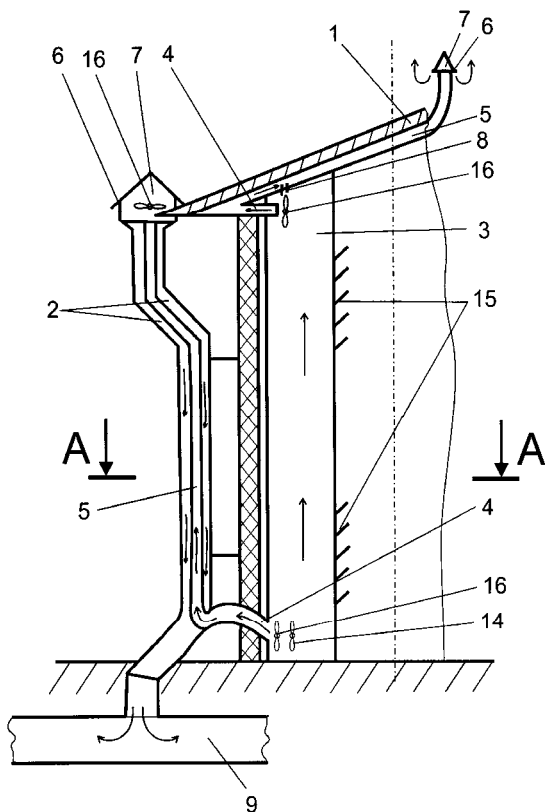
Разрез здания с подводом теплоносителя как в толщу кровли, так и в полость водосточной трубы: 1 — наклонная кровля; 2 — водосточные трубы; 3 — вытяжные системы; 4 — каналы; 5 — средства переноса; 6 — выпускные коллекторы; 7 — козырьки-оголовки; 8 — дренажные каналы; 9 — традиционная канализация; 10, 11 — водосточные трубы; 12 — круговые каналы; 13 — кольцевые каналы; 14 — тепловентиляторы; 15 — впускные коллекторы; 16 — вентиляторы
